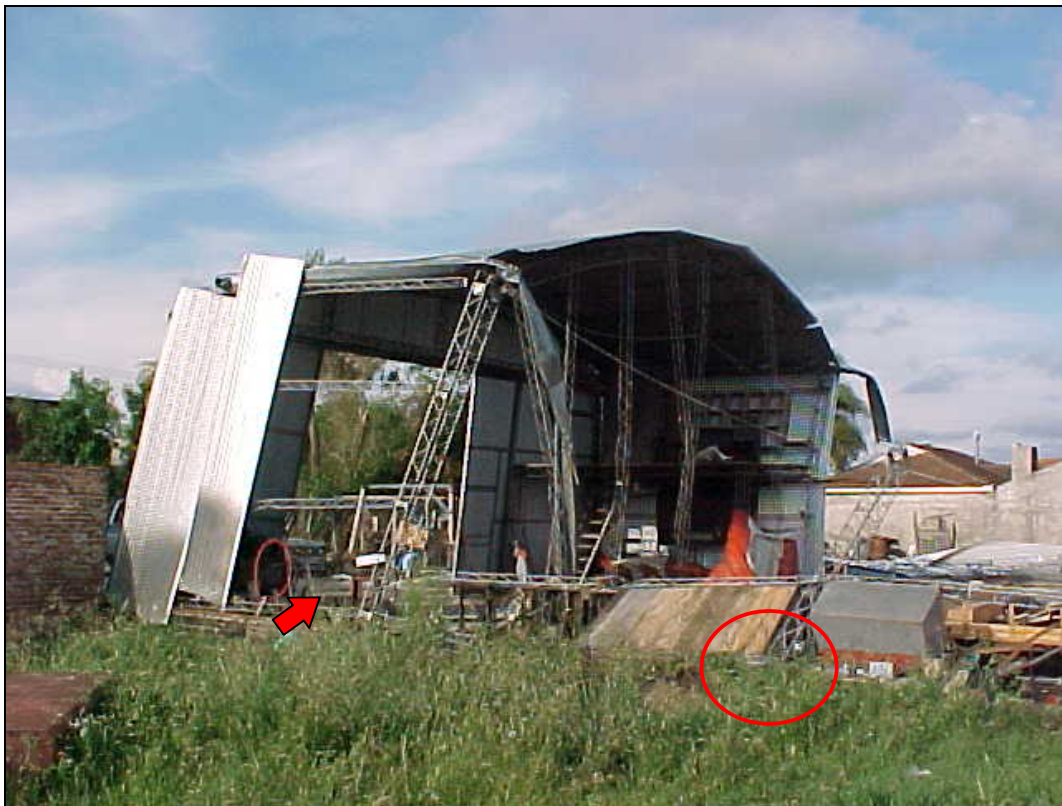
Levantamiento de fundaciones y falla de pórtico por empuje horizontal coplanar (SPRFV).
